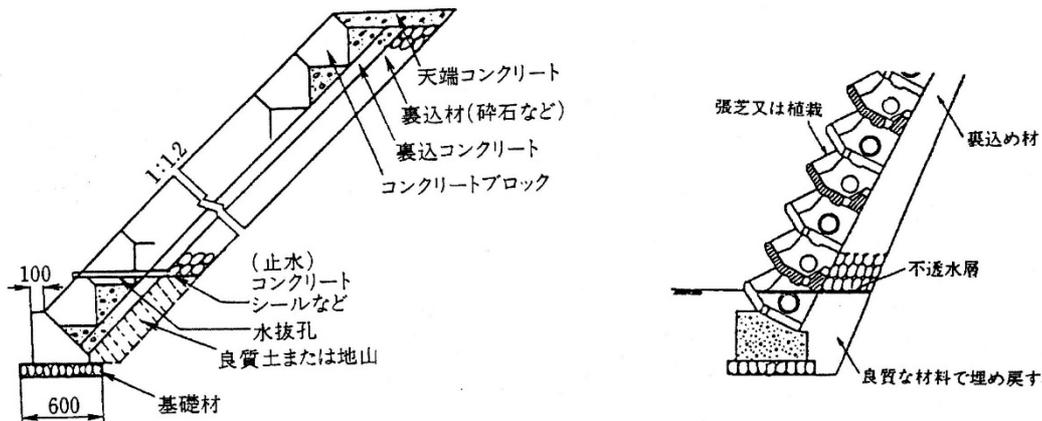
コンクリートブロック張工の例・緑化ブロックの例
